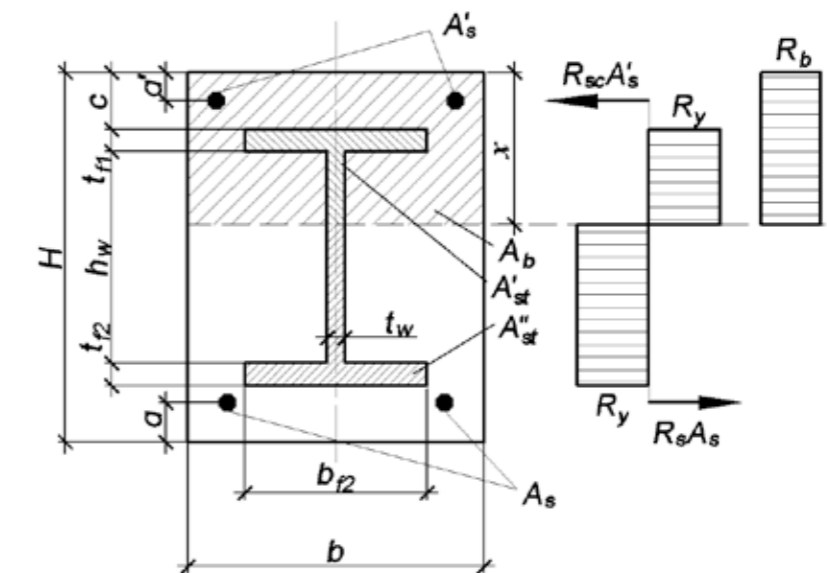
Случай, когда нейтральная ось пересекает стенку жесткой арматуры в обетонированной балке прямоугольного сечения
